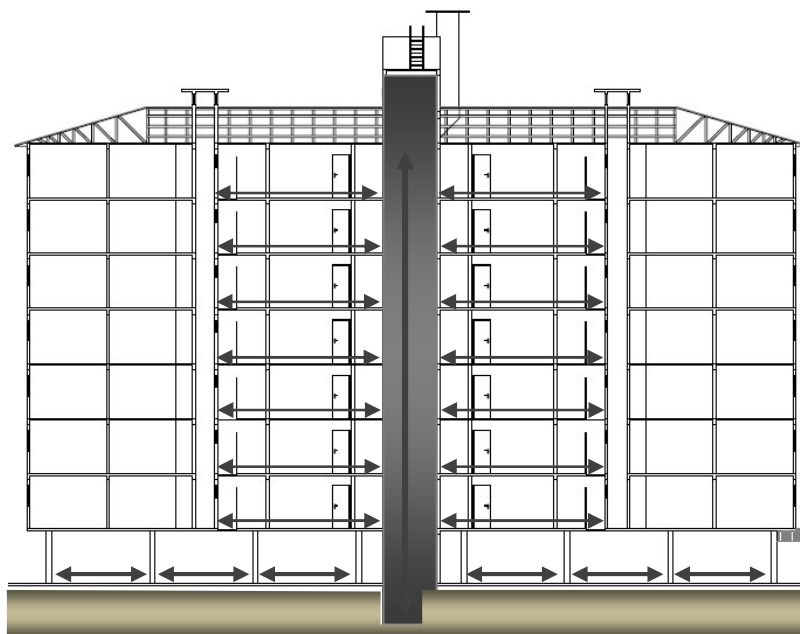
Fluxo de moradores no pavimento tipo da edificação.
